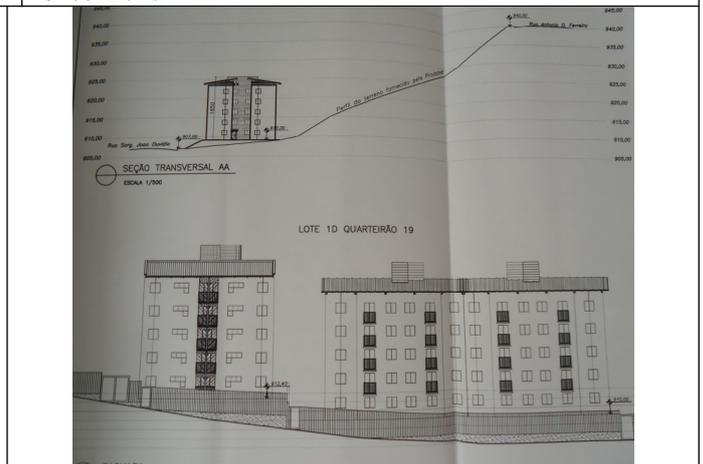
Vista lateral e fachadas frontais do empreendimento 01.
